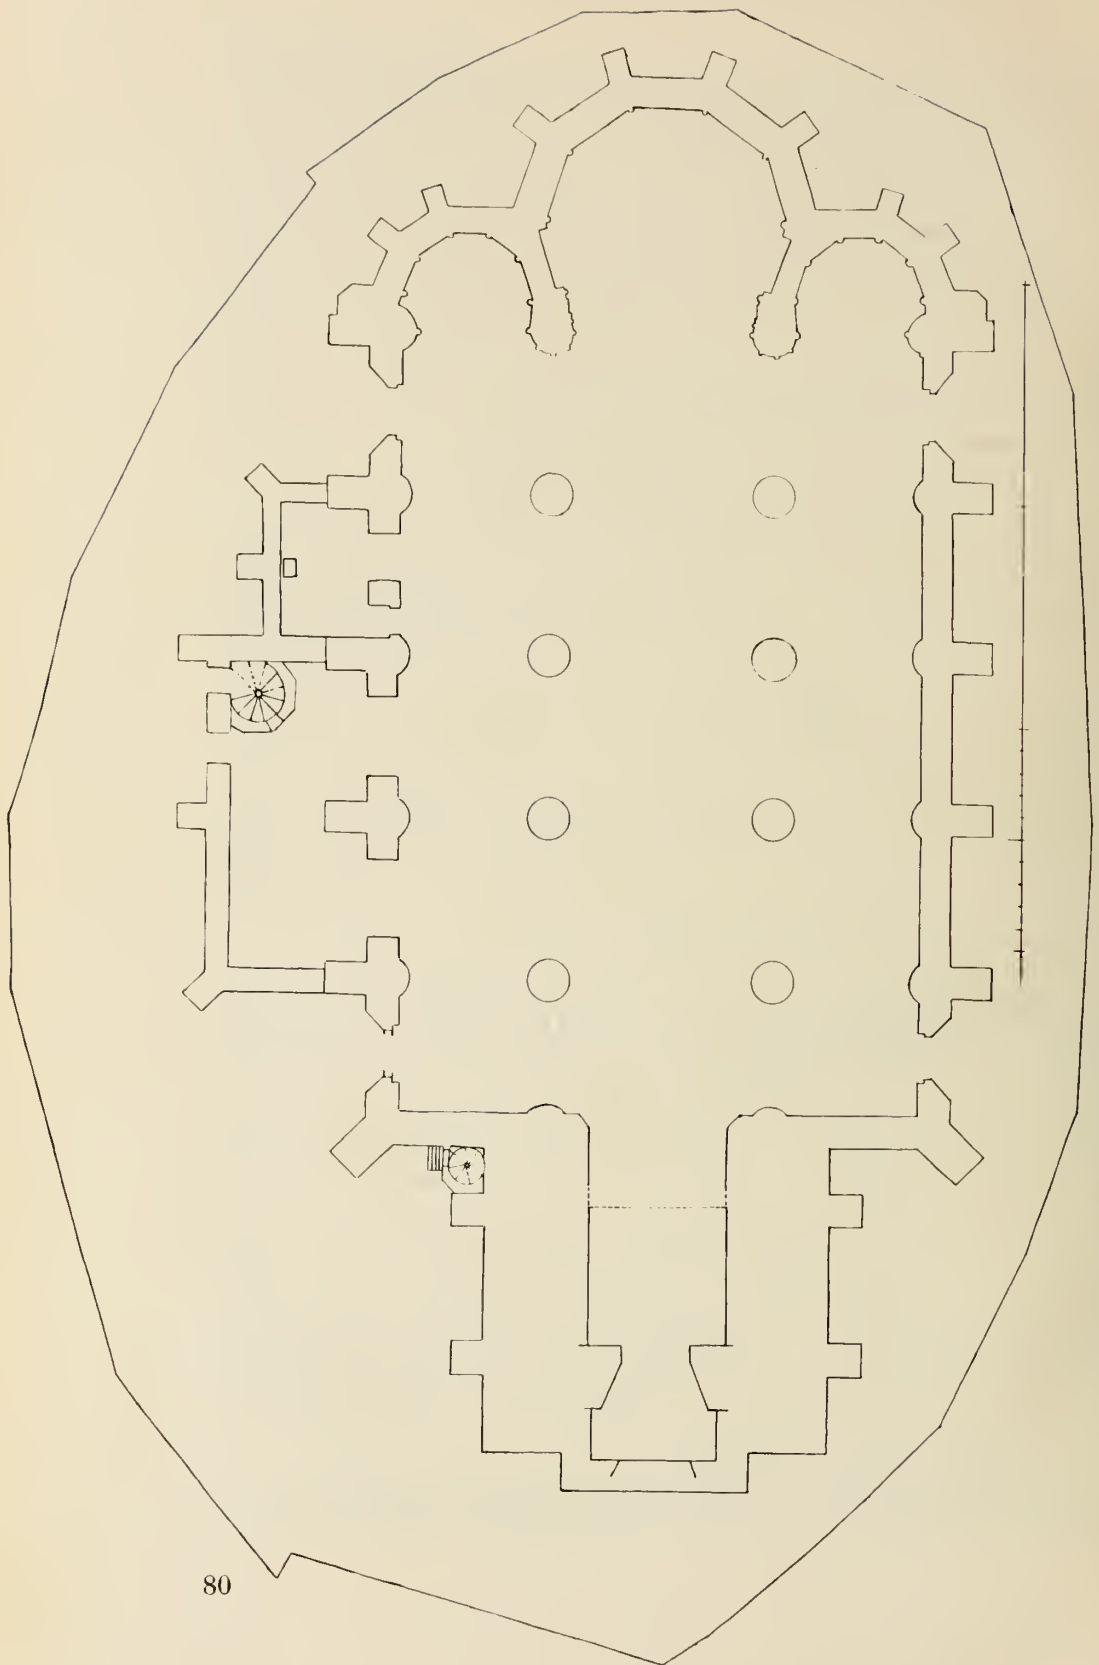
Hannover; Marktkirche; Grundriß nach dem Plan von Balhasar Weimberg, 1684. Kusterel der Marktkirche.
